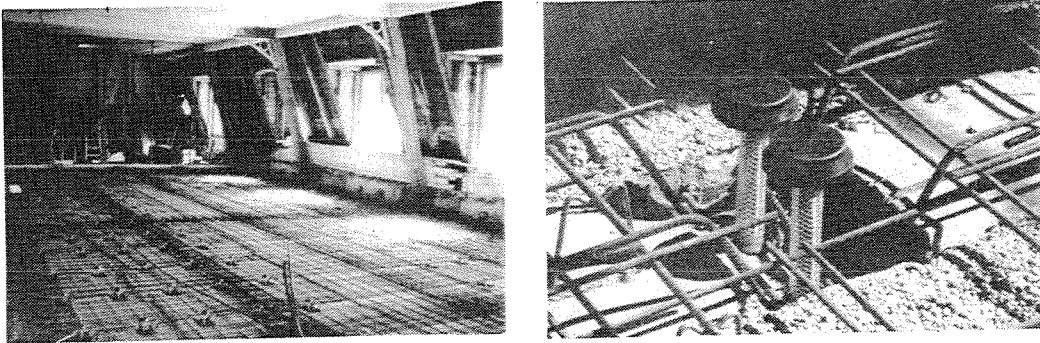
Sanierung alter Holzbalkendecken in Holz-Beton-Verbundbauweise
